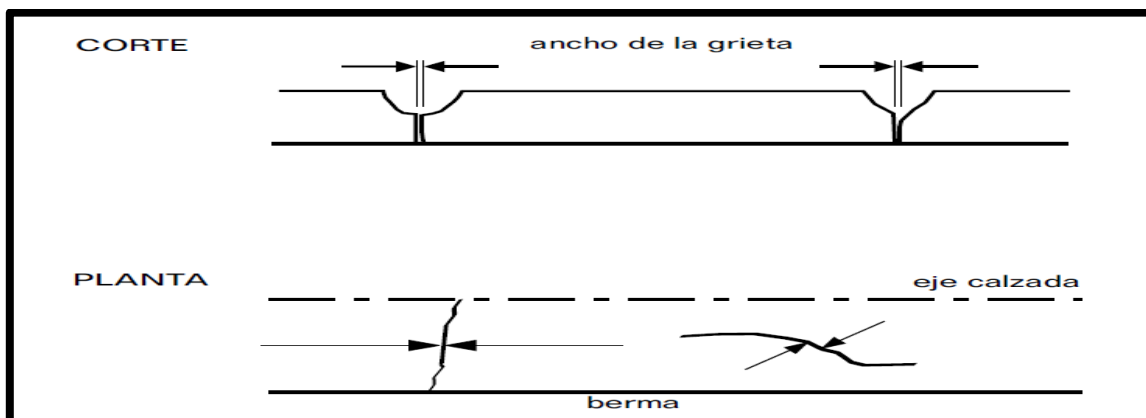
Parámetro de medición de grietas. Fuente [17].
